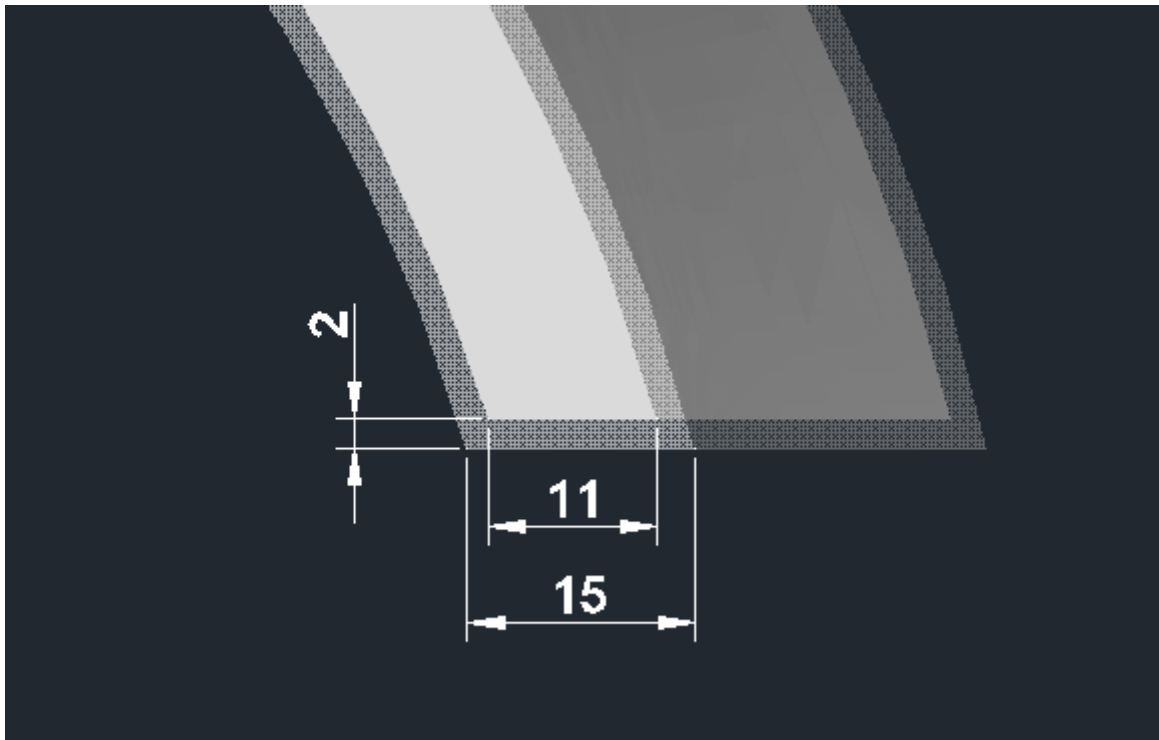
Detalhe das dimensões de espessura da telha GePET.
